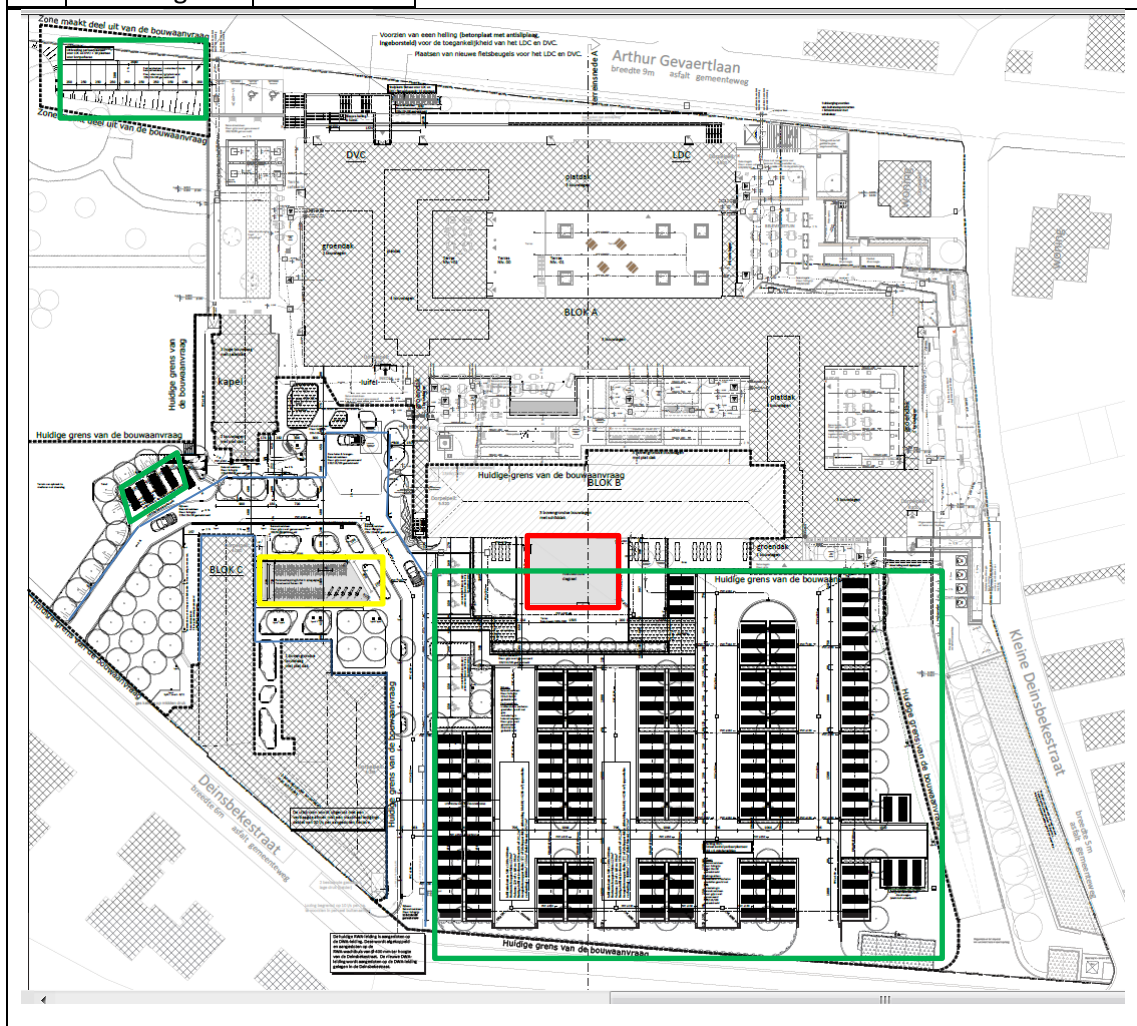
Detail grondplan met weergave van aanbouw aan de westzijde van gebouw B en omringende structuren (bron: Boeckx Architecten 2016).
